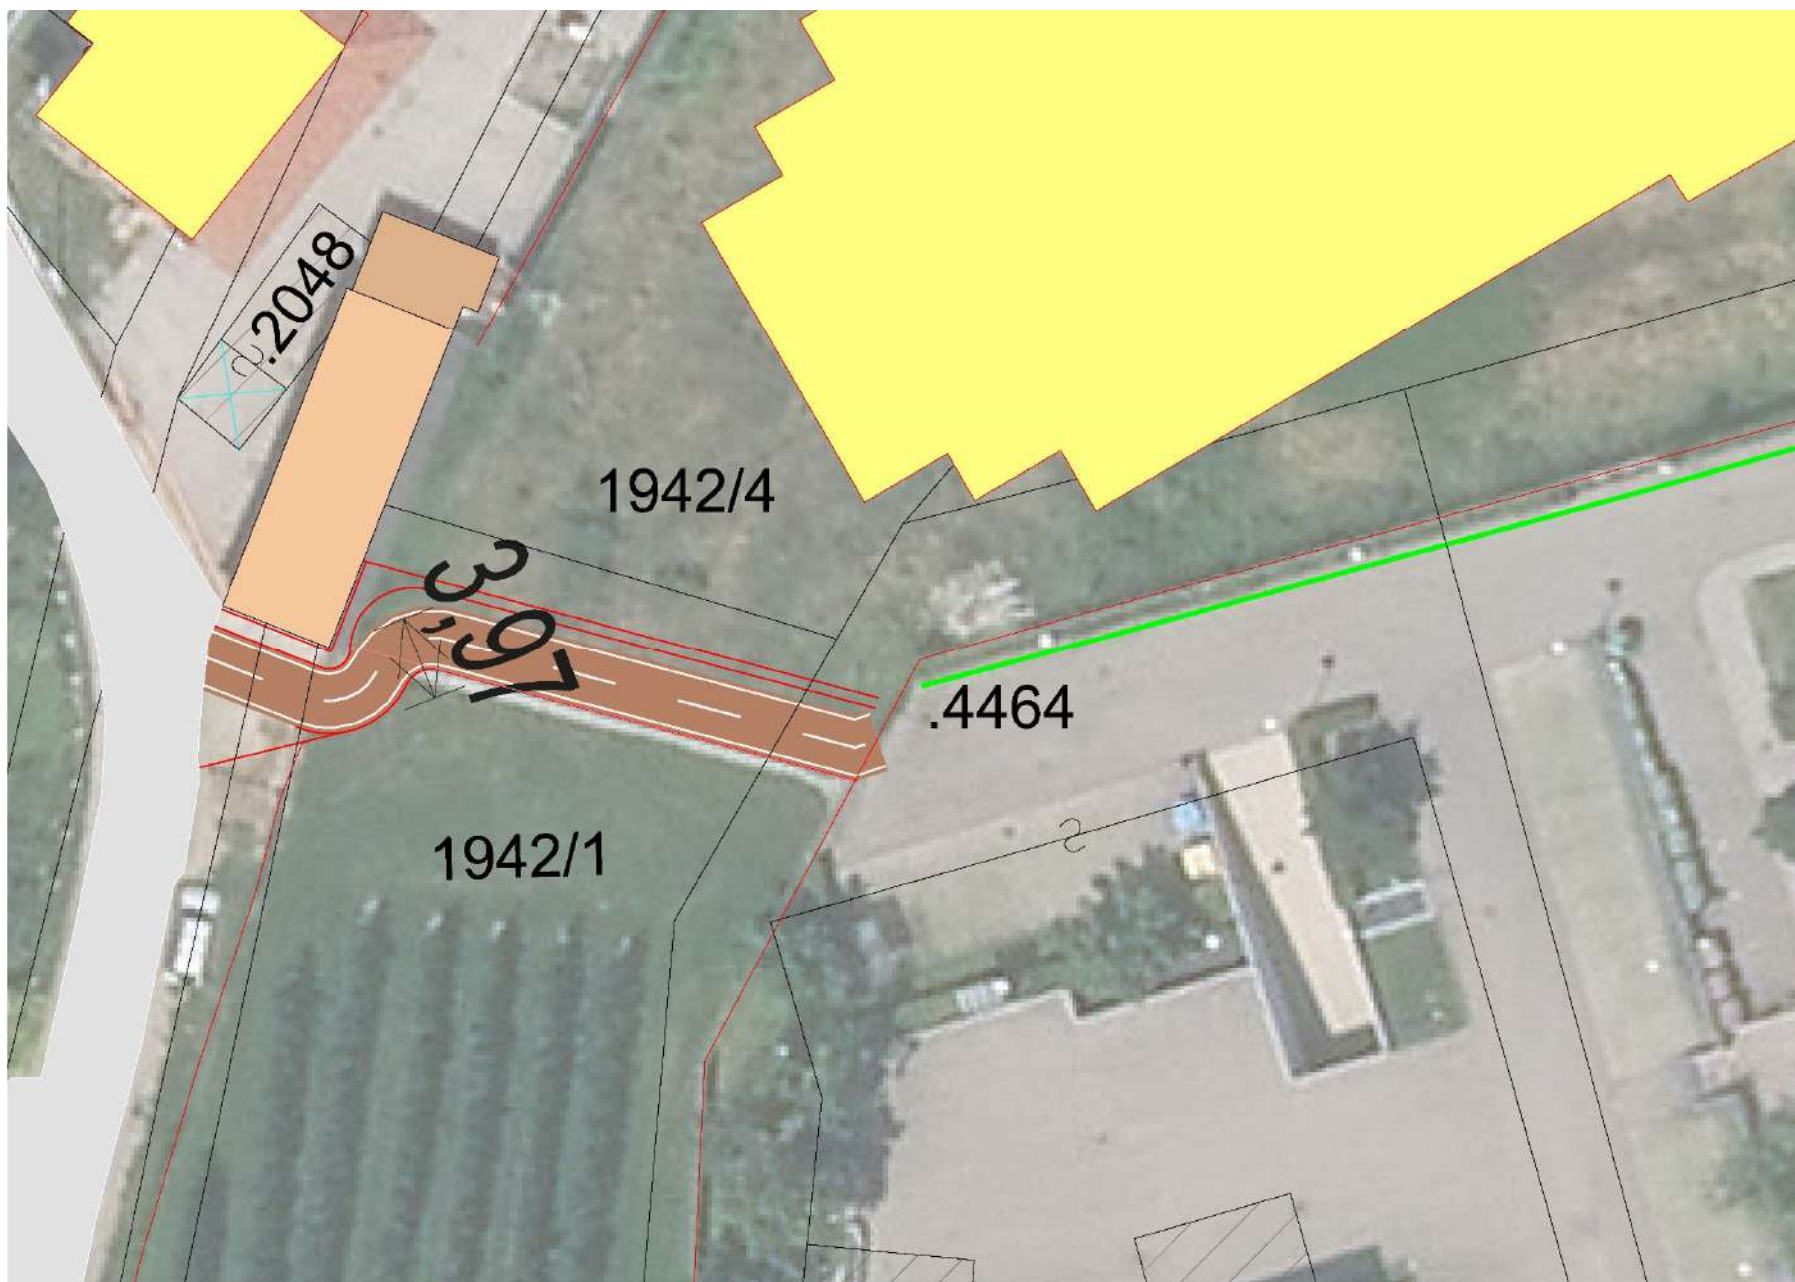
Ciclabile ponte Adige e Castel Firmiano (7) - Planimetria di progetto (dettaglio clinica Waldner)
